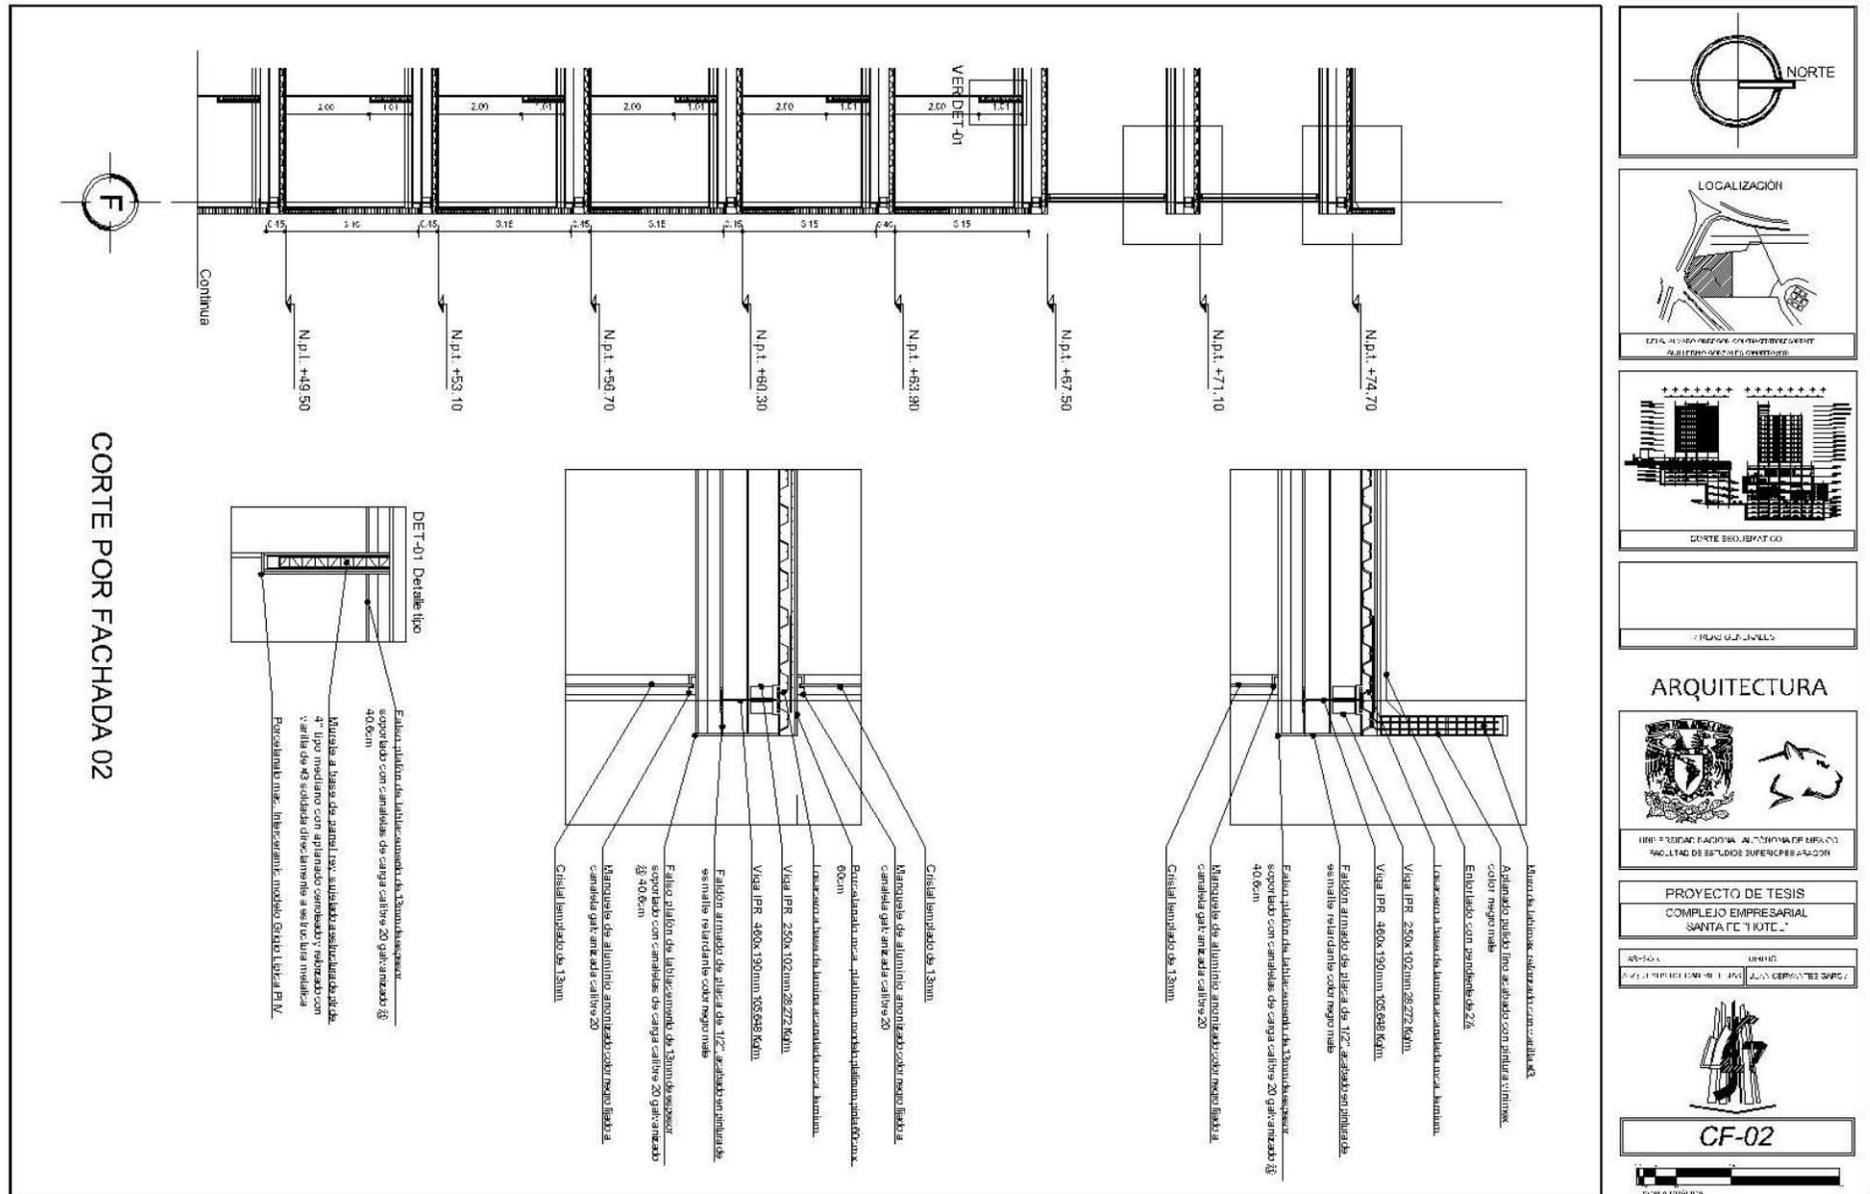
Plano CF-02; Corte por Fachada Hotel y Centro Comercial. Edición propia.
